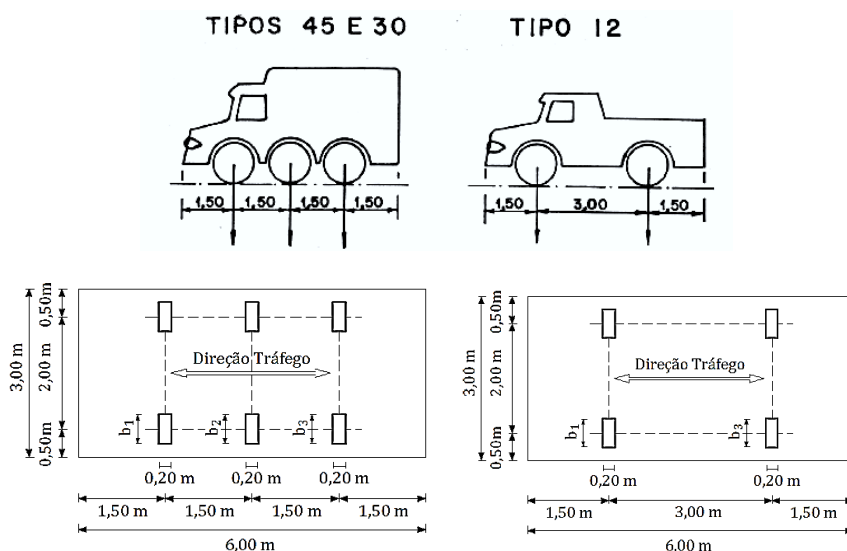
Dimensões dos veículos tipos previsto na norma Brasileira, em perfil longitudinal (em cima) e em planta (em baixo) (NBR-7188, 1982).
